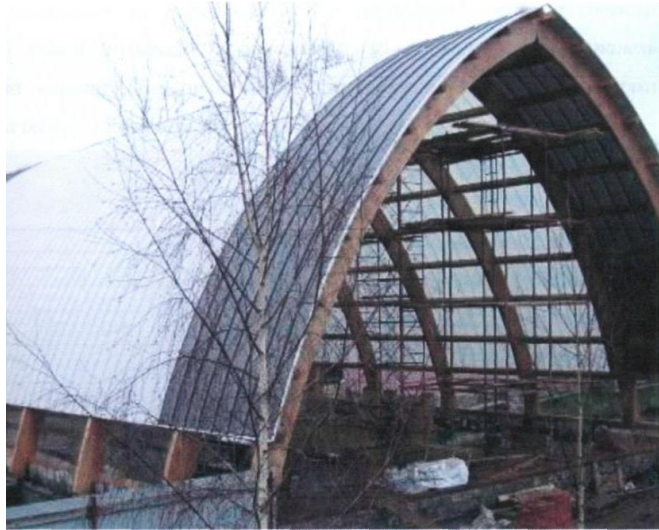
Конструктивна схема для безкранової промислової будівлі із застосуванням гнотоклесних дерев'яних стрільчатих арок
